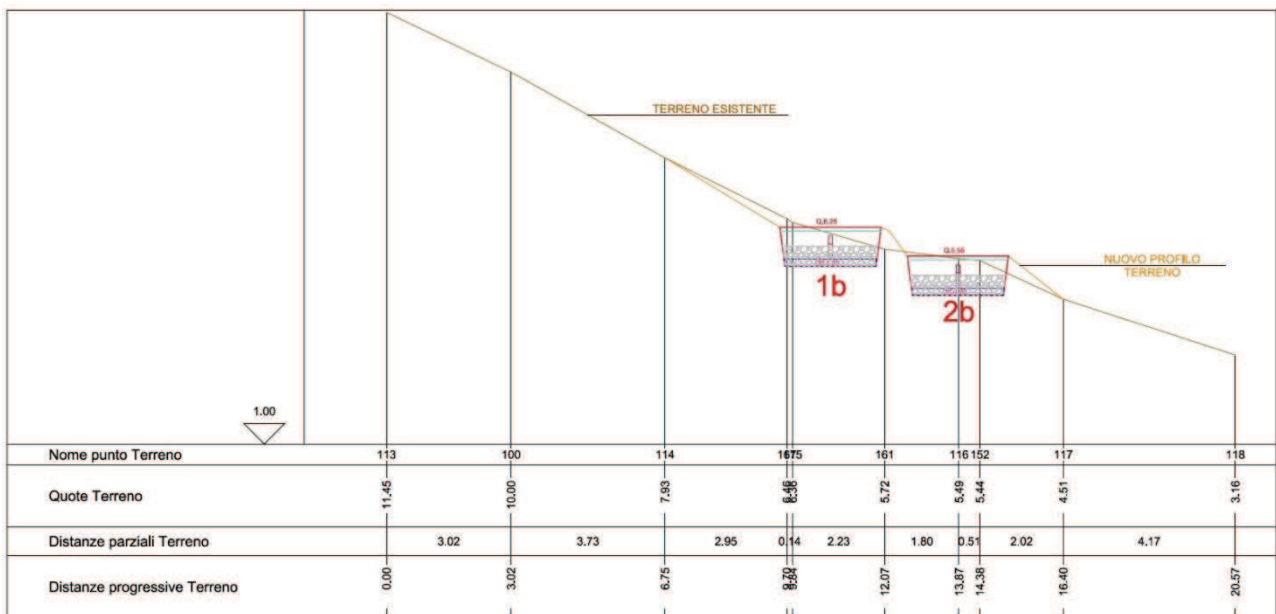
Sezione A-A' 1:100; (fonte: Parco dell'Adamello)
